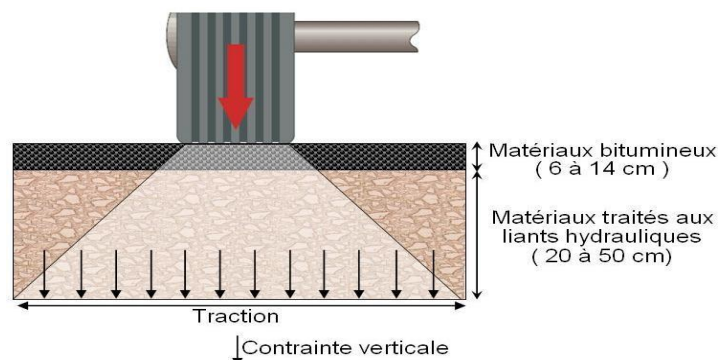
Chaussées à assise traités au liant hydraulique (chaussée semi-rigide).
